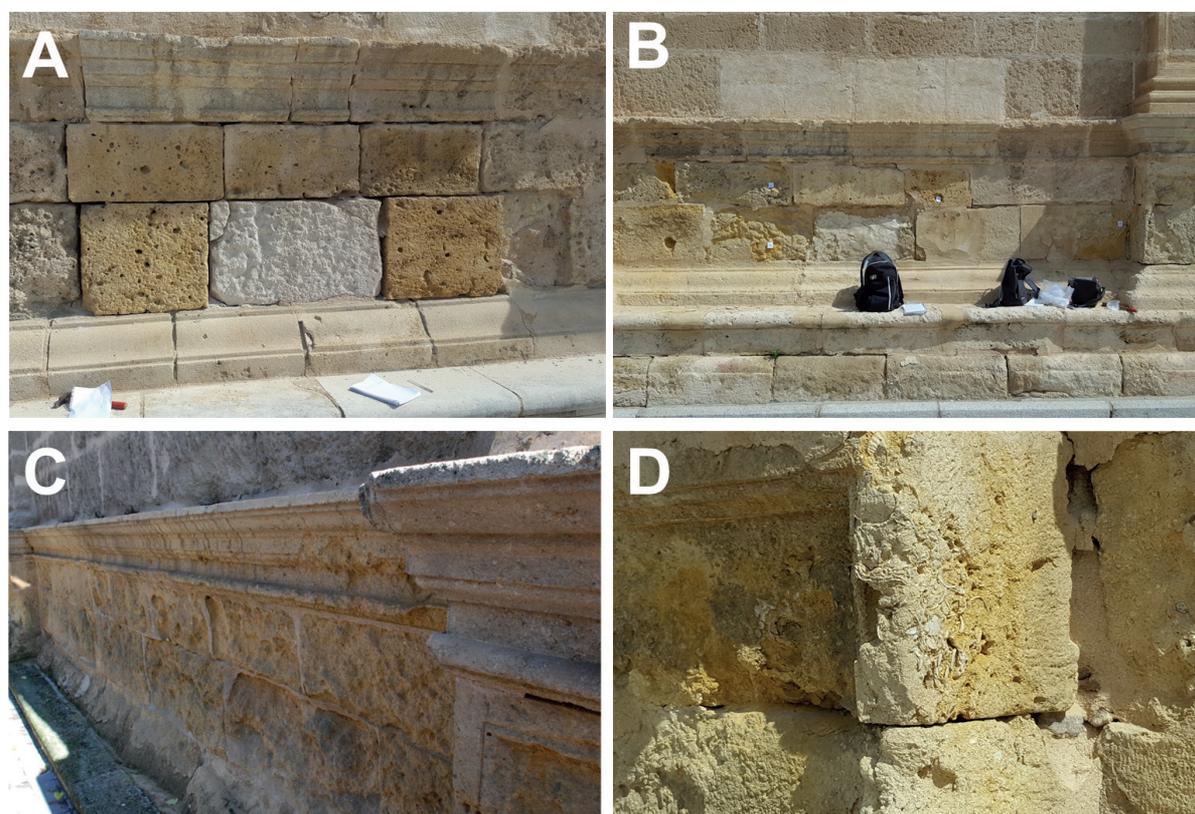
Distintas zonas de los zócalos de las fachadas exteriores con numerosos tipos de piedras de sustitución. A) todos los litotipos B) Piedra Alcor y morteros C) Alcor variedad muy alterable. D) piedra de Niebla. Fotografías de Jesús Espinosa Gaitán.
